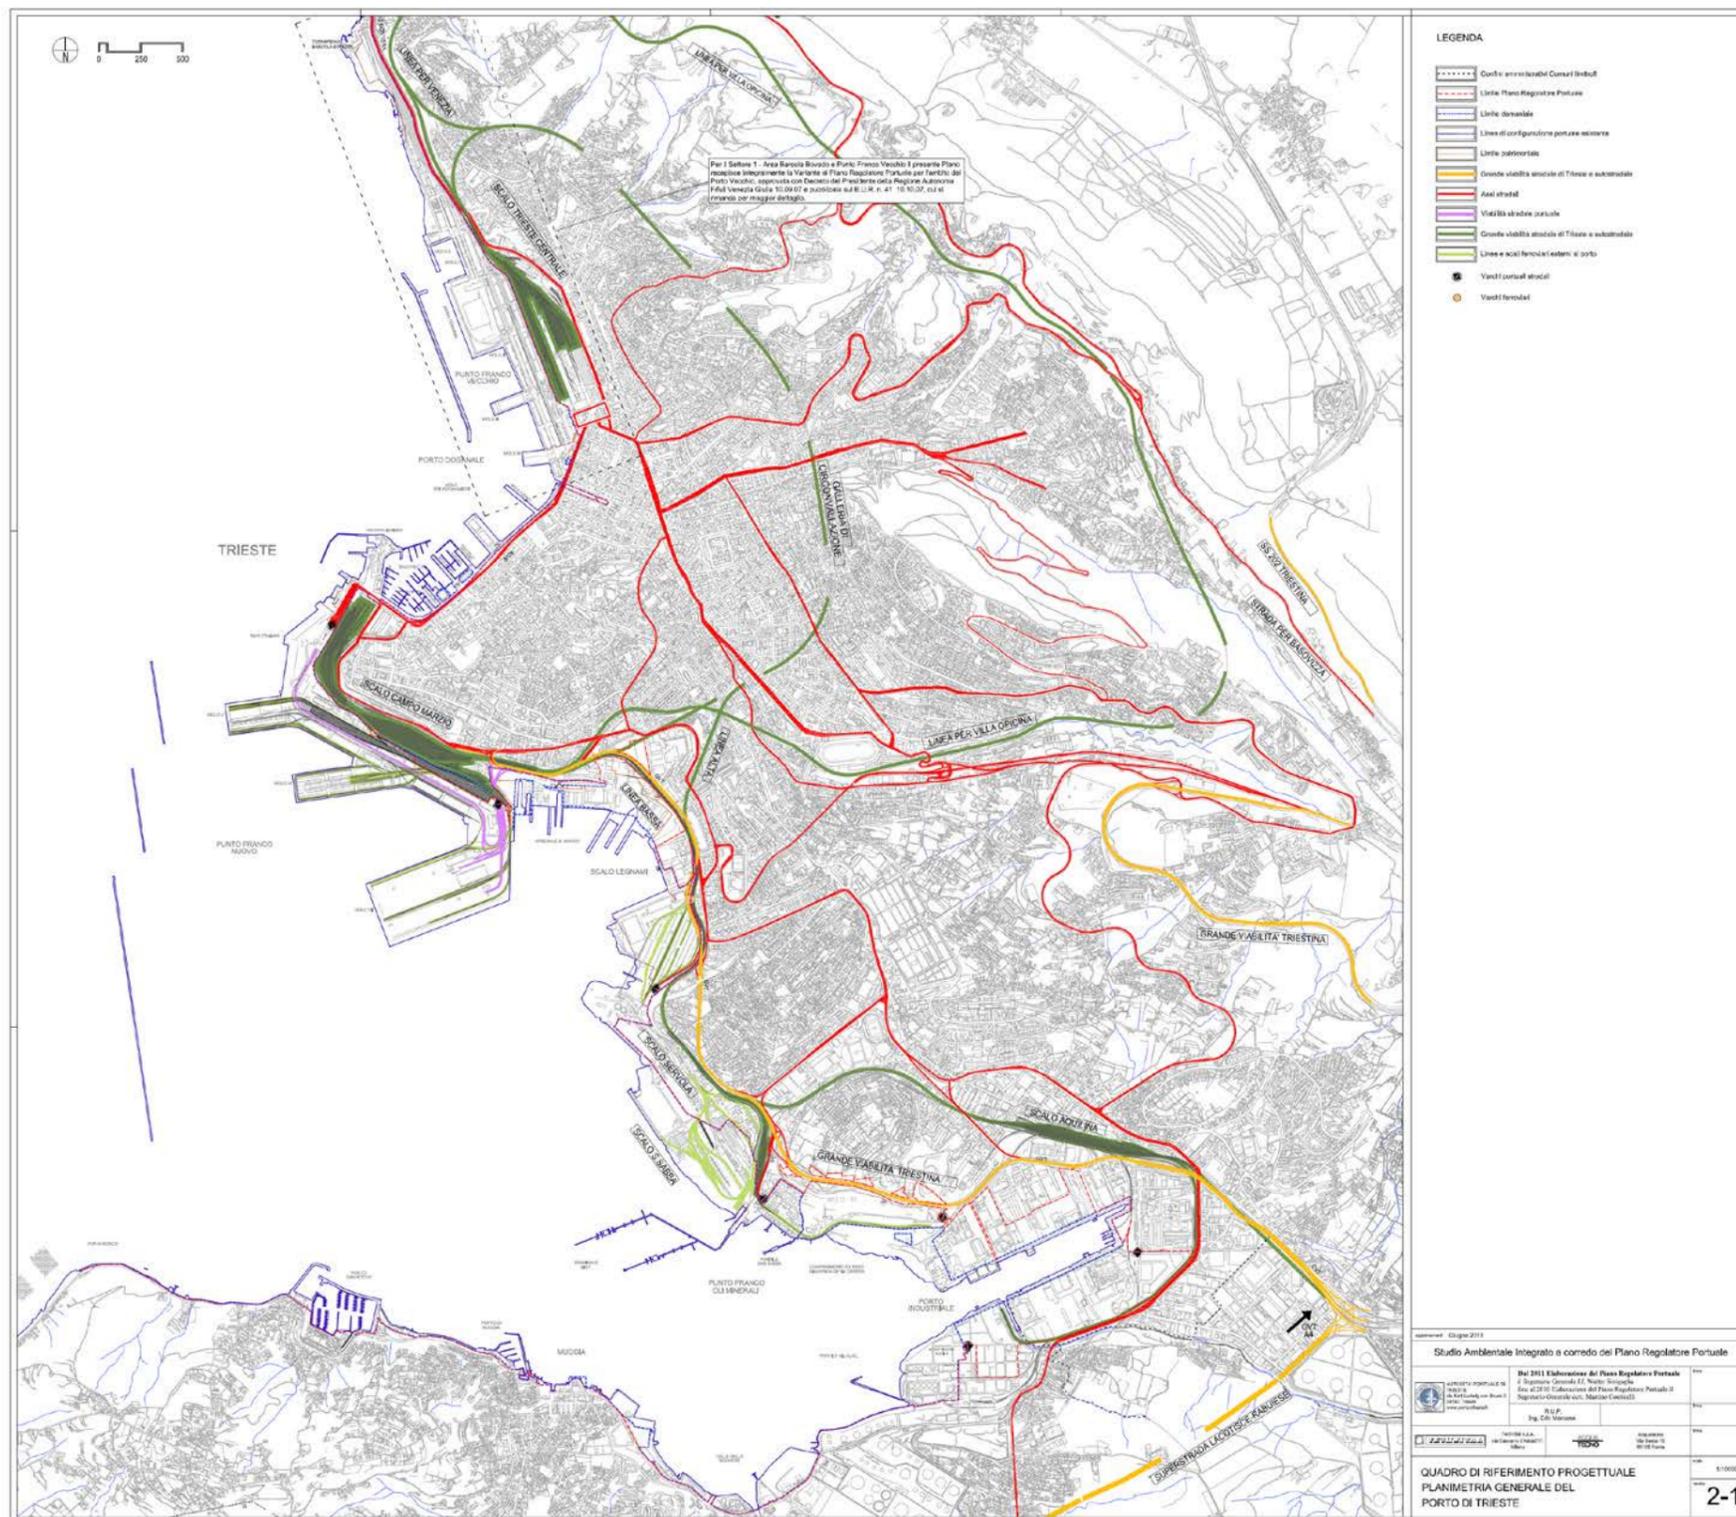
PLANIMETRIA GENERALE DEL PORTO DI TRIESTE.
